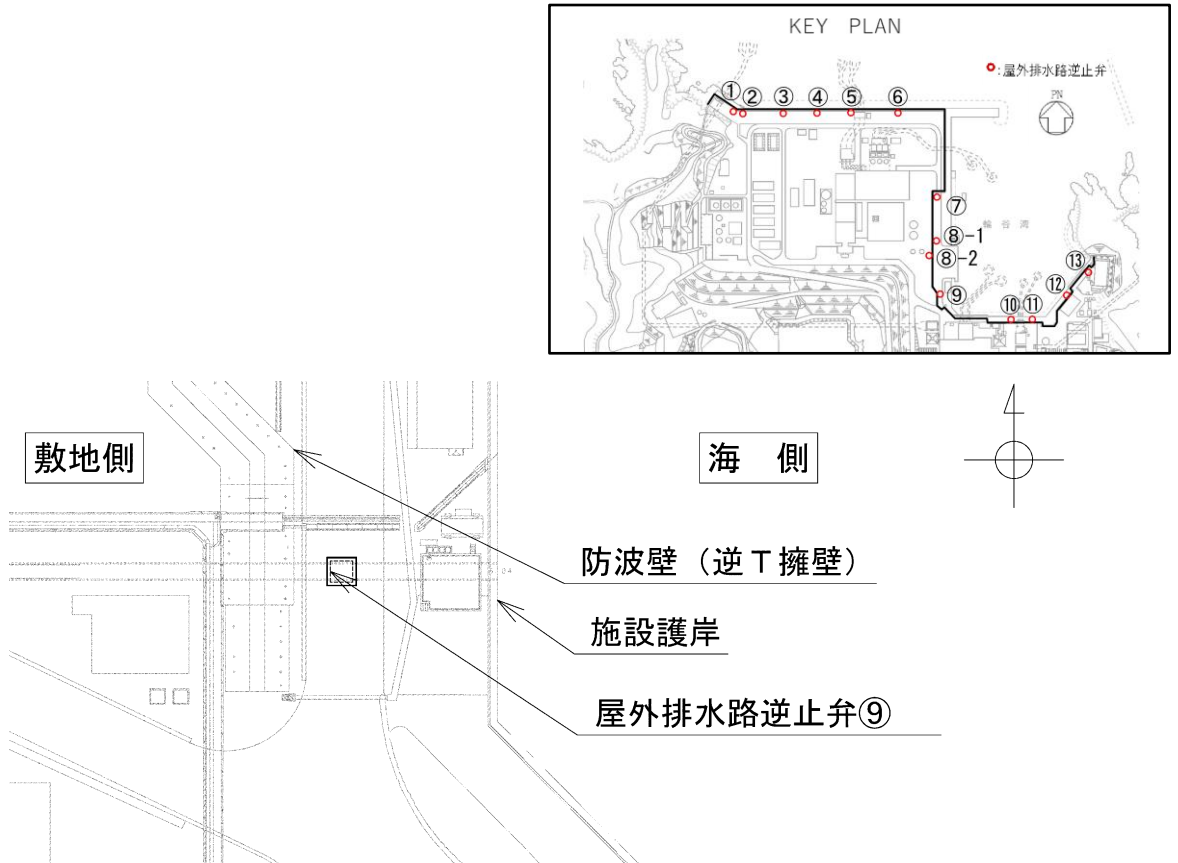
(1) 屋外排水路逆止弁⑨平面図
